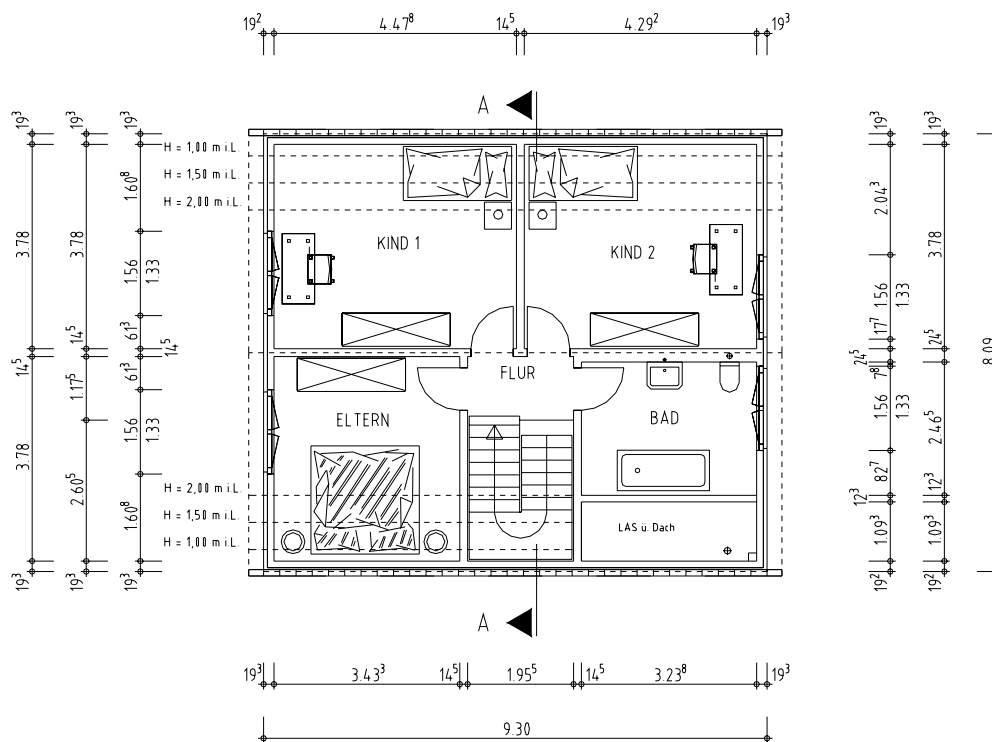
Grundriss Dachgeschoss des Basishauses
